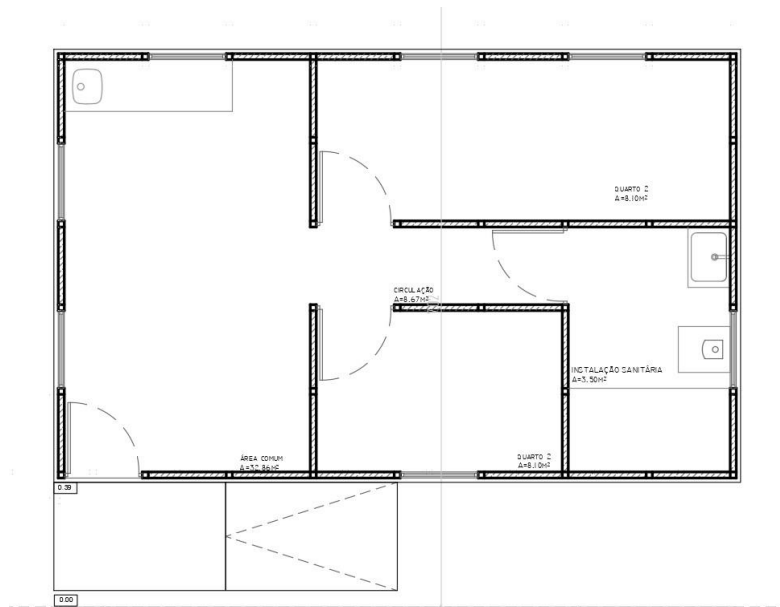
Planta piso O Módulo Familiar (Fonte: Autor)
